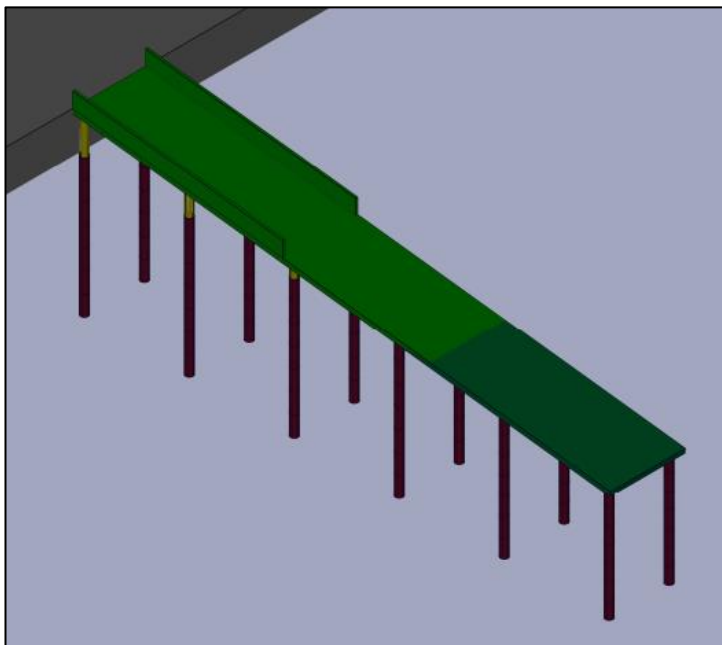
Projeto conceitual de rampa em concreto armado (3D).
